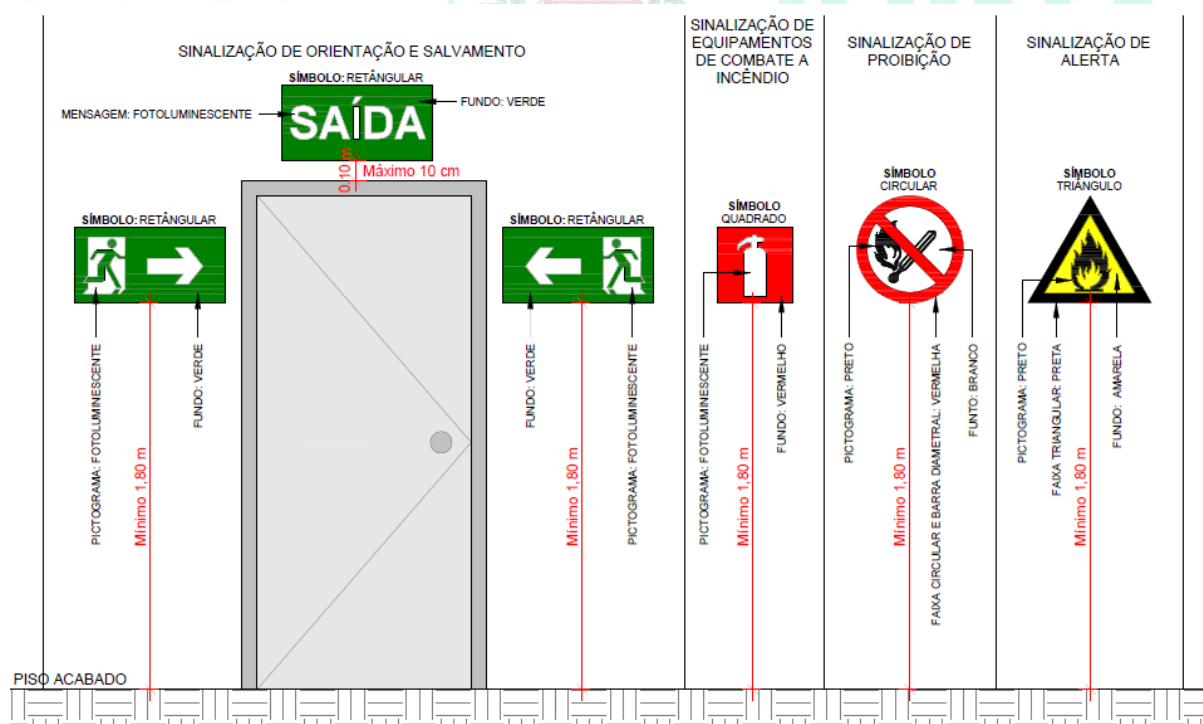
detalhe das placas de sinalização de emergência e instalação.
